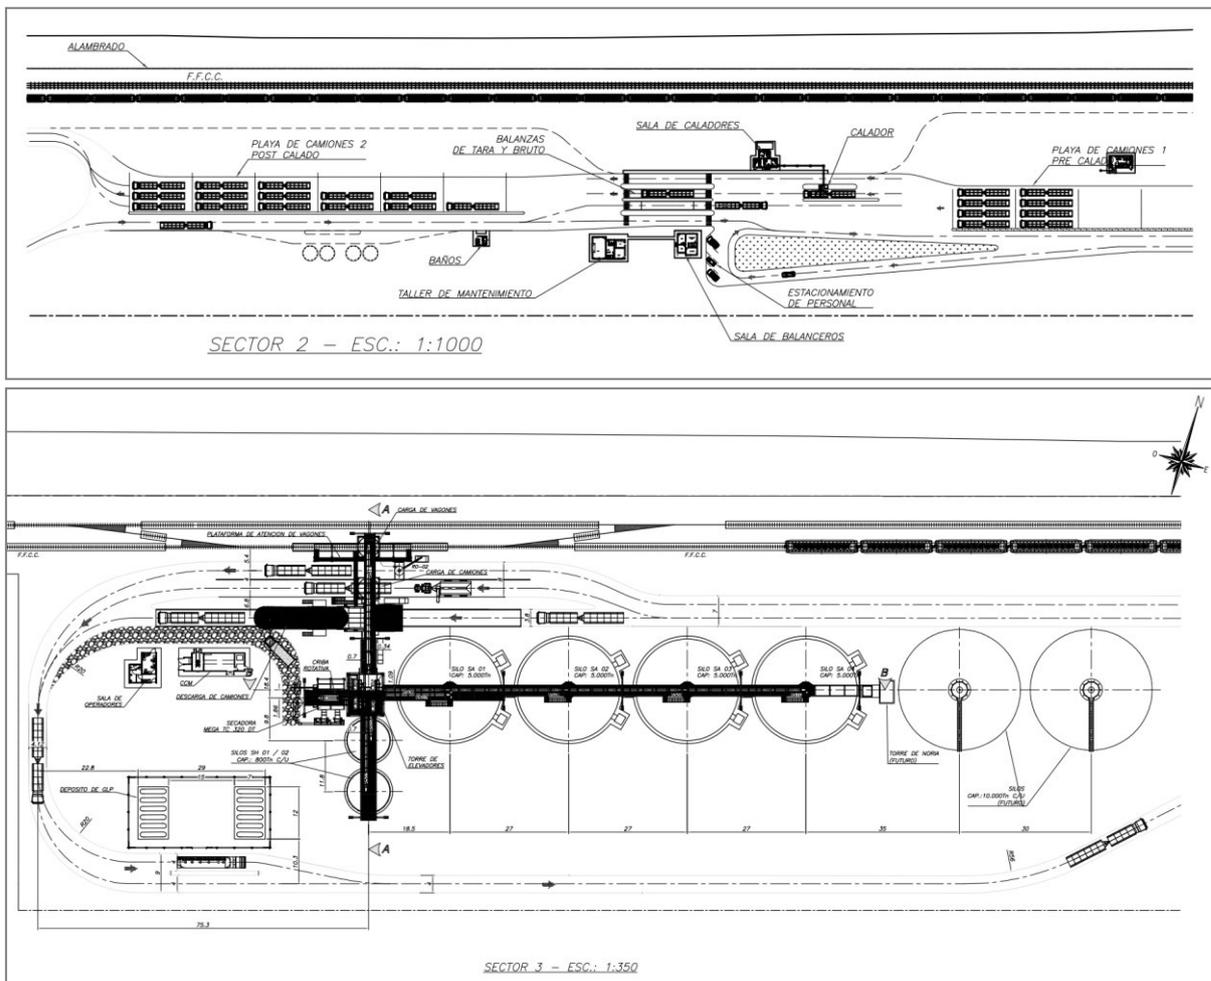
Layout de la Planta. Fuente: Excel Consulting
